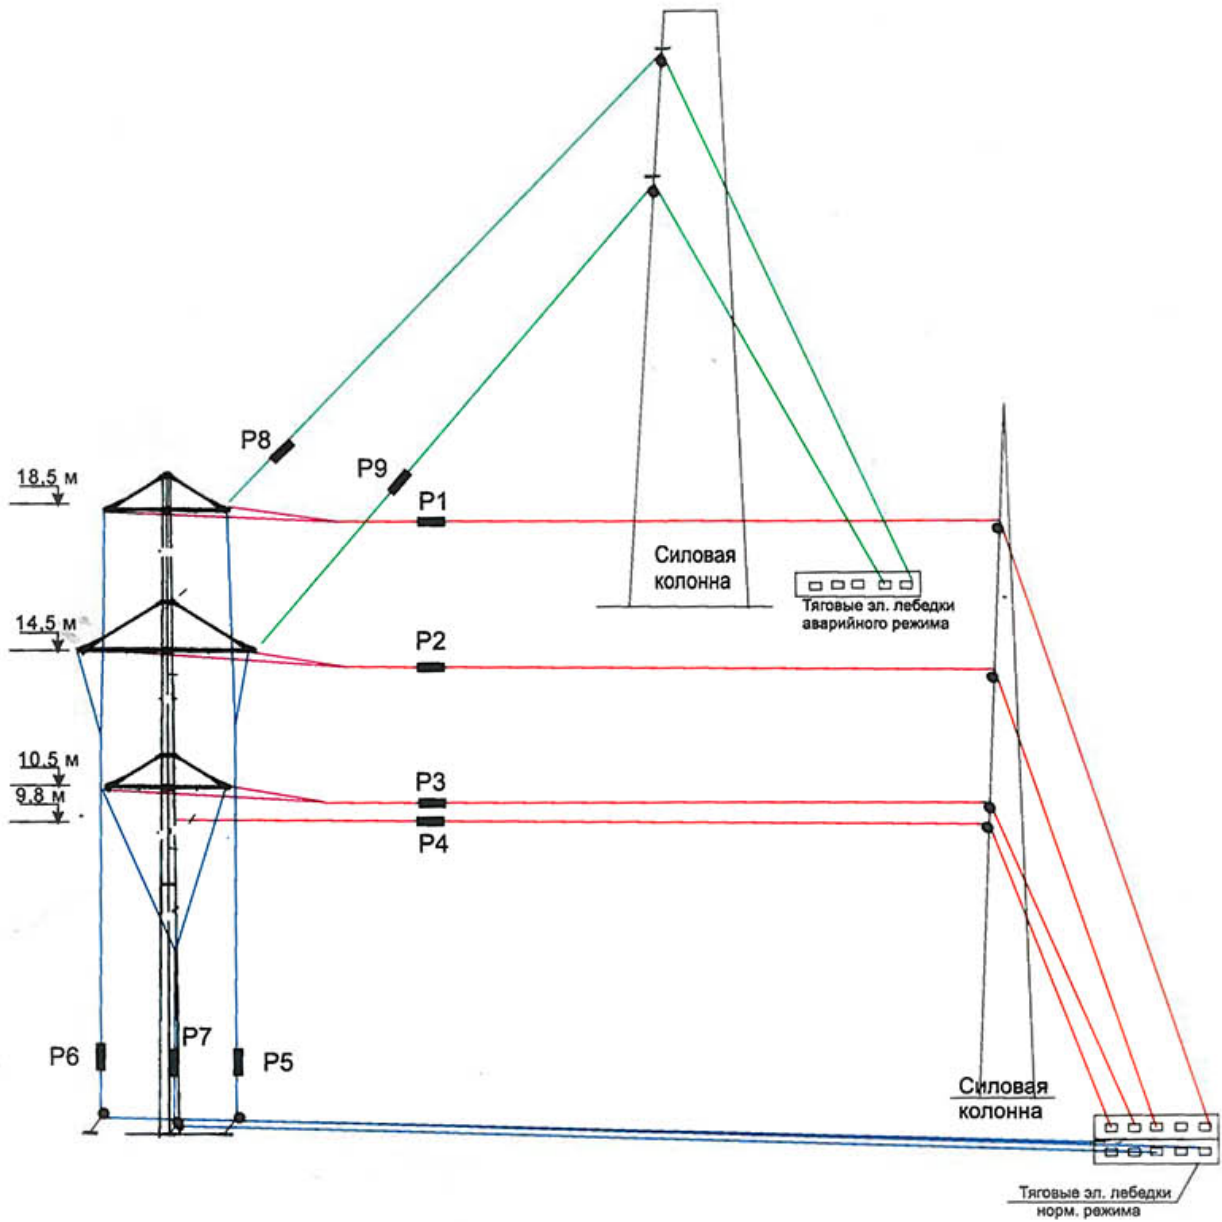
Общая схема задания нагрузок при испытании опоры ПМ35-4
